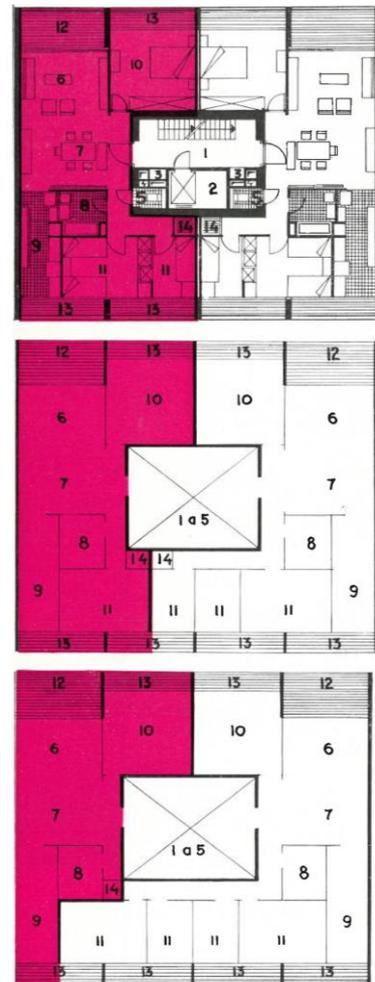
Plan de distribution extensible d'un immeuble du secteur Croix-Rouge.
